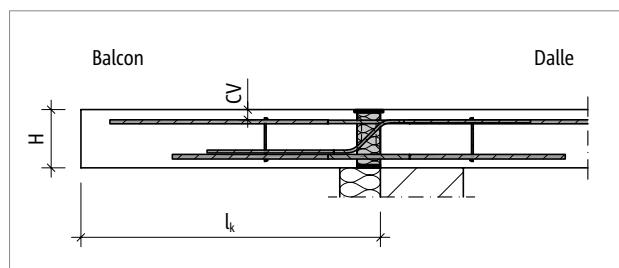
Schöck Isokorb® T types K-M13 et M14 : système statique
